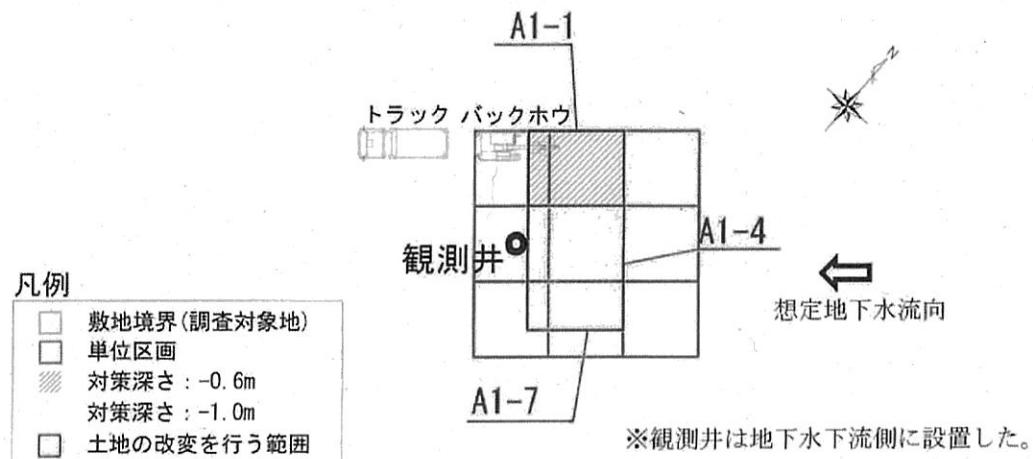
土地の改変の施工方法を明らかにした図面(掘削平面図)
